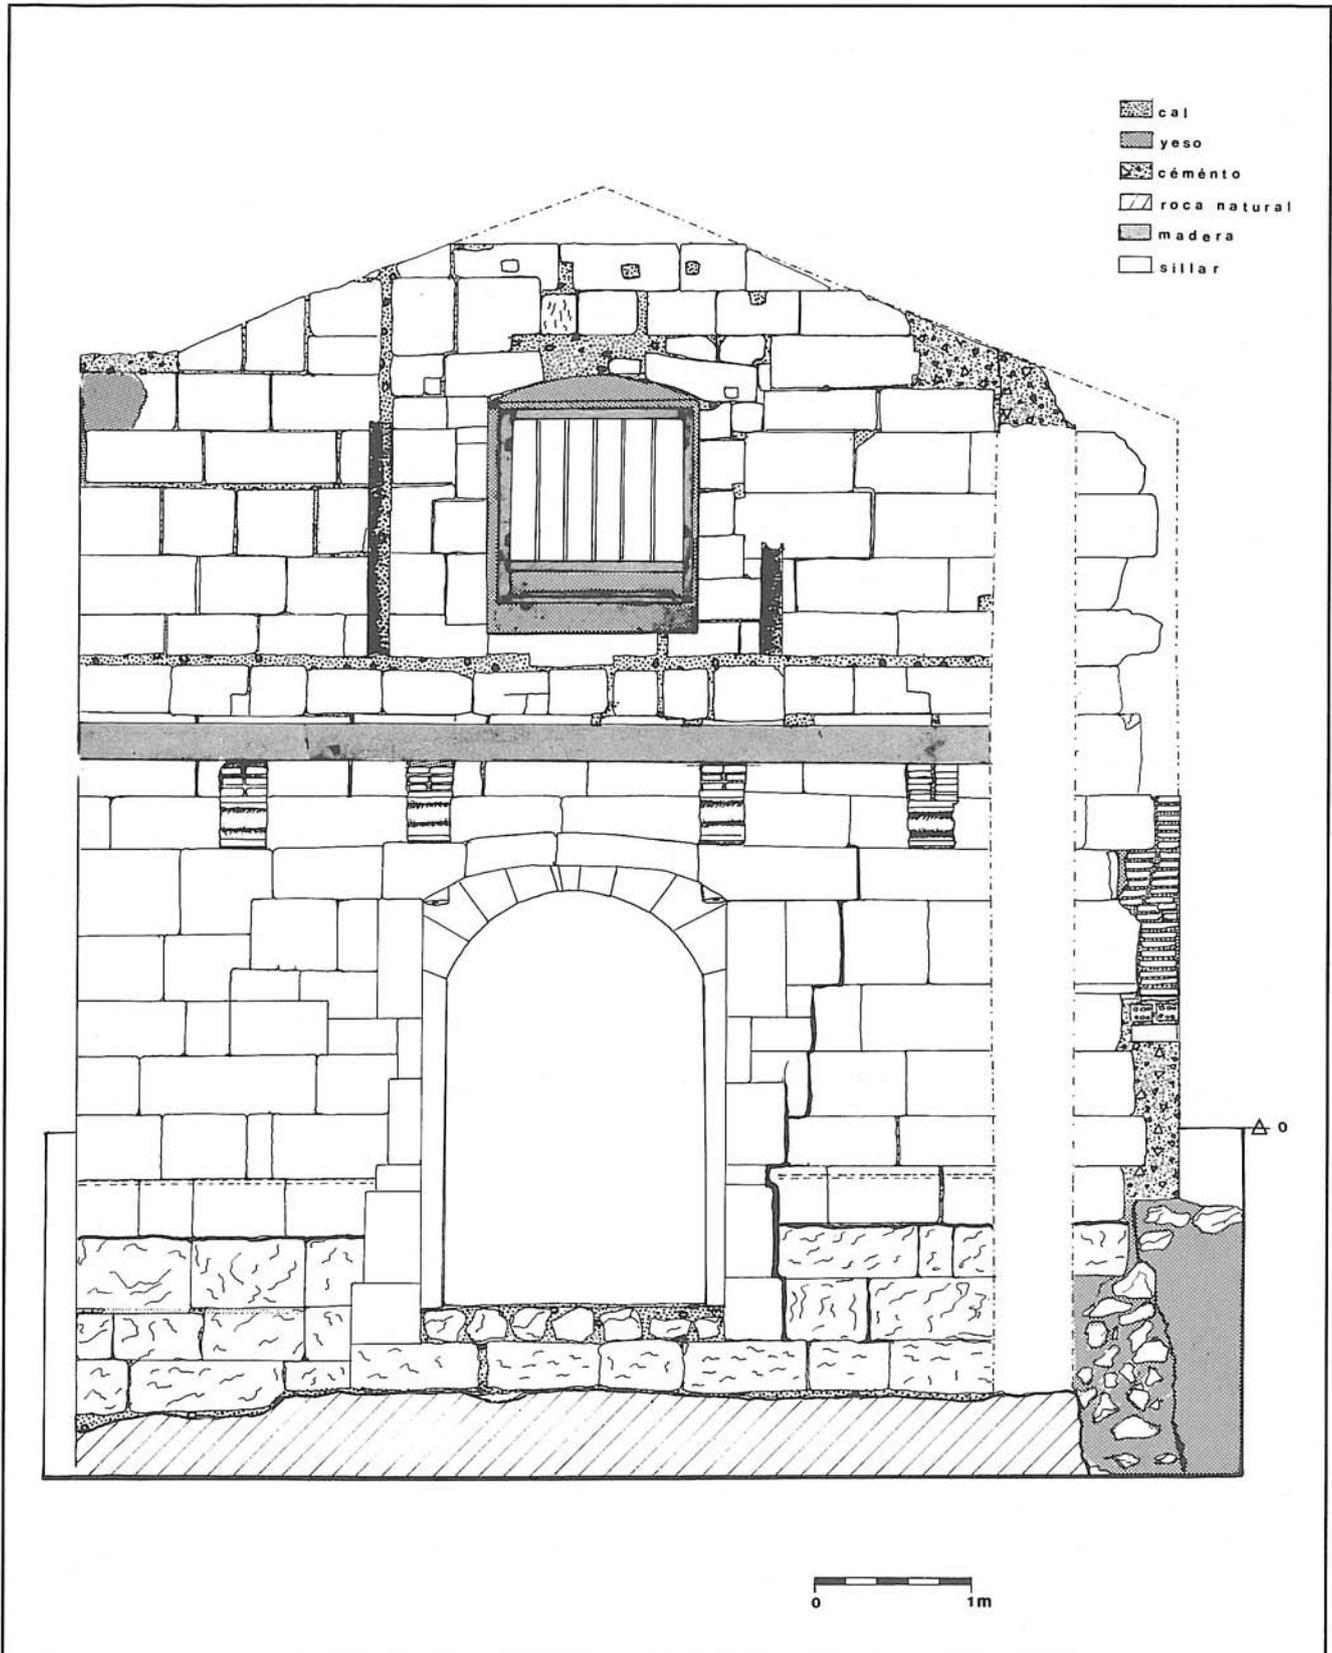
Santa María del Rabal. Jumilla. Alzado pared interior de la Iglesia.
